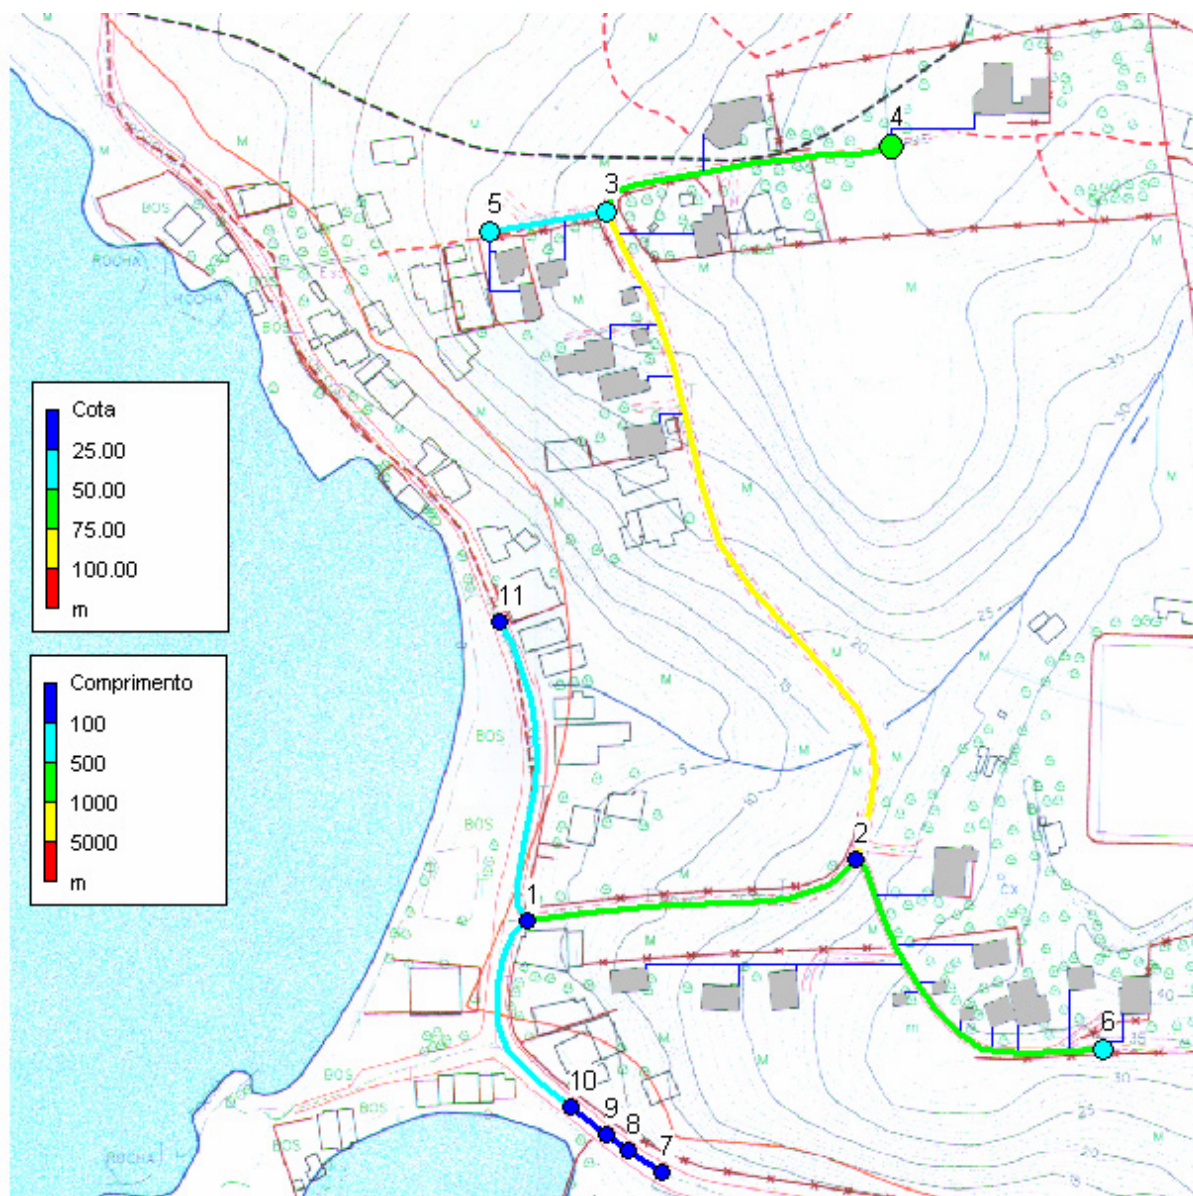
Mapa plani-altimétrico da área piloto (Ponta do Sambaqui).
